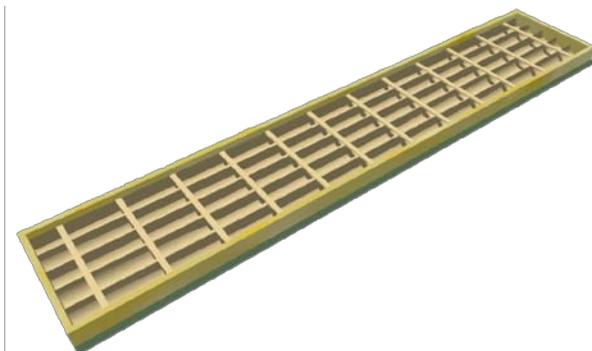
Colocação do Bambu para fabricar o painel de laje
